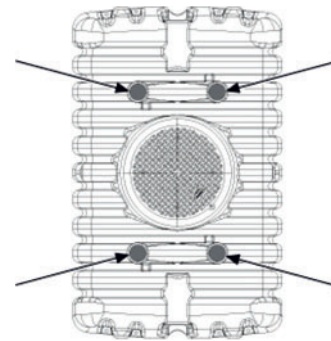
Posiciones tubos de soporte – FLAT S/M
